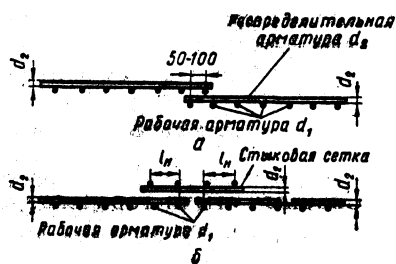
Устройство стыков сварных сеток в нерабочем направлении:
